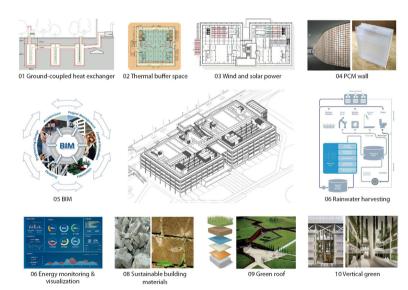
永安栈房设计中的十大绿色生态技术(图片来源:上海创盟国际建筑设计有限公司提供) Figure 9. Schematic proposal for the Yong'an Warehouse renovation (Source: Archi-Union
